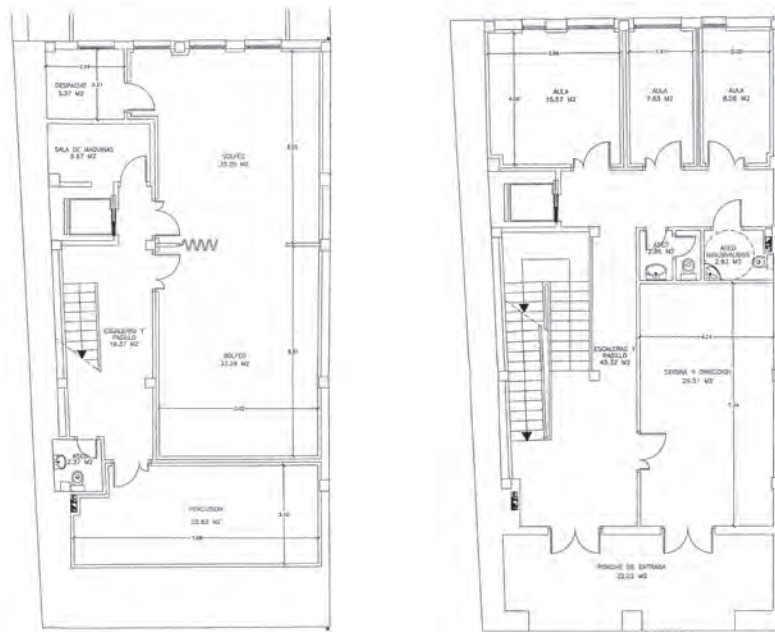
17. 1996 PLANTA SEMISÓTANO Y PLANTA BAJA
